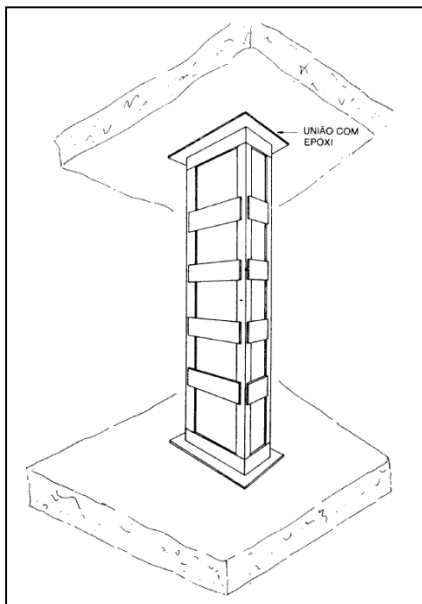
Pilar reforçado com armaduras exteriores (TAKEUTI, 1999).
